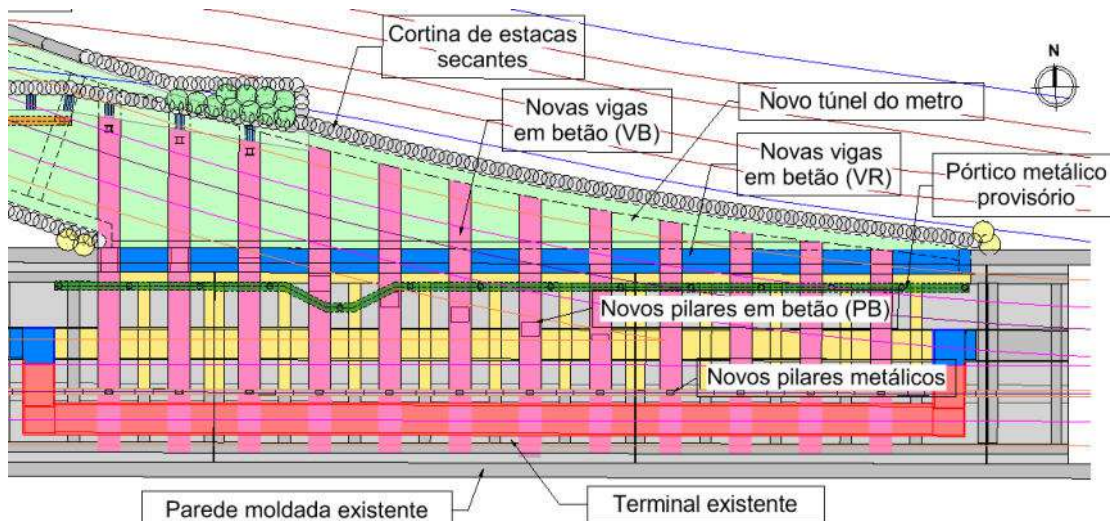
Planta de Dimensionamento de Demolições e novas Estruturas a executar e a preservar
